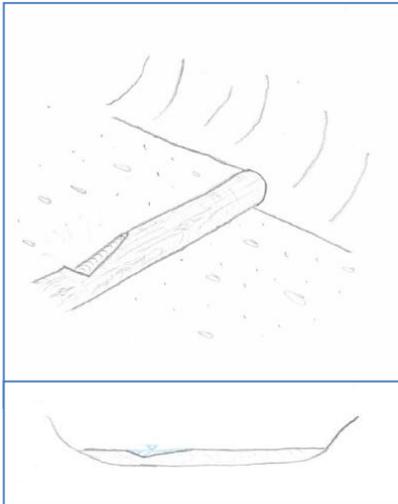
Ausgeschnittene Niederwasserrinne in einer Holzsohlschwelle
